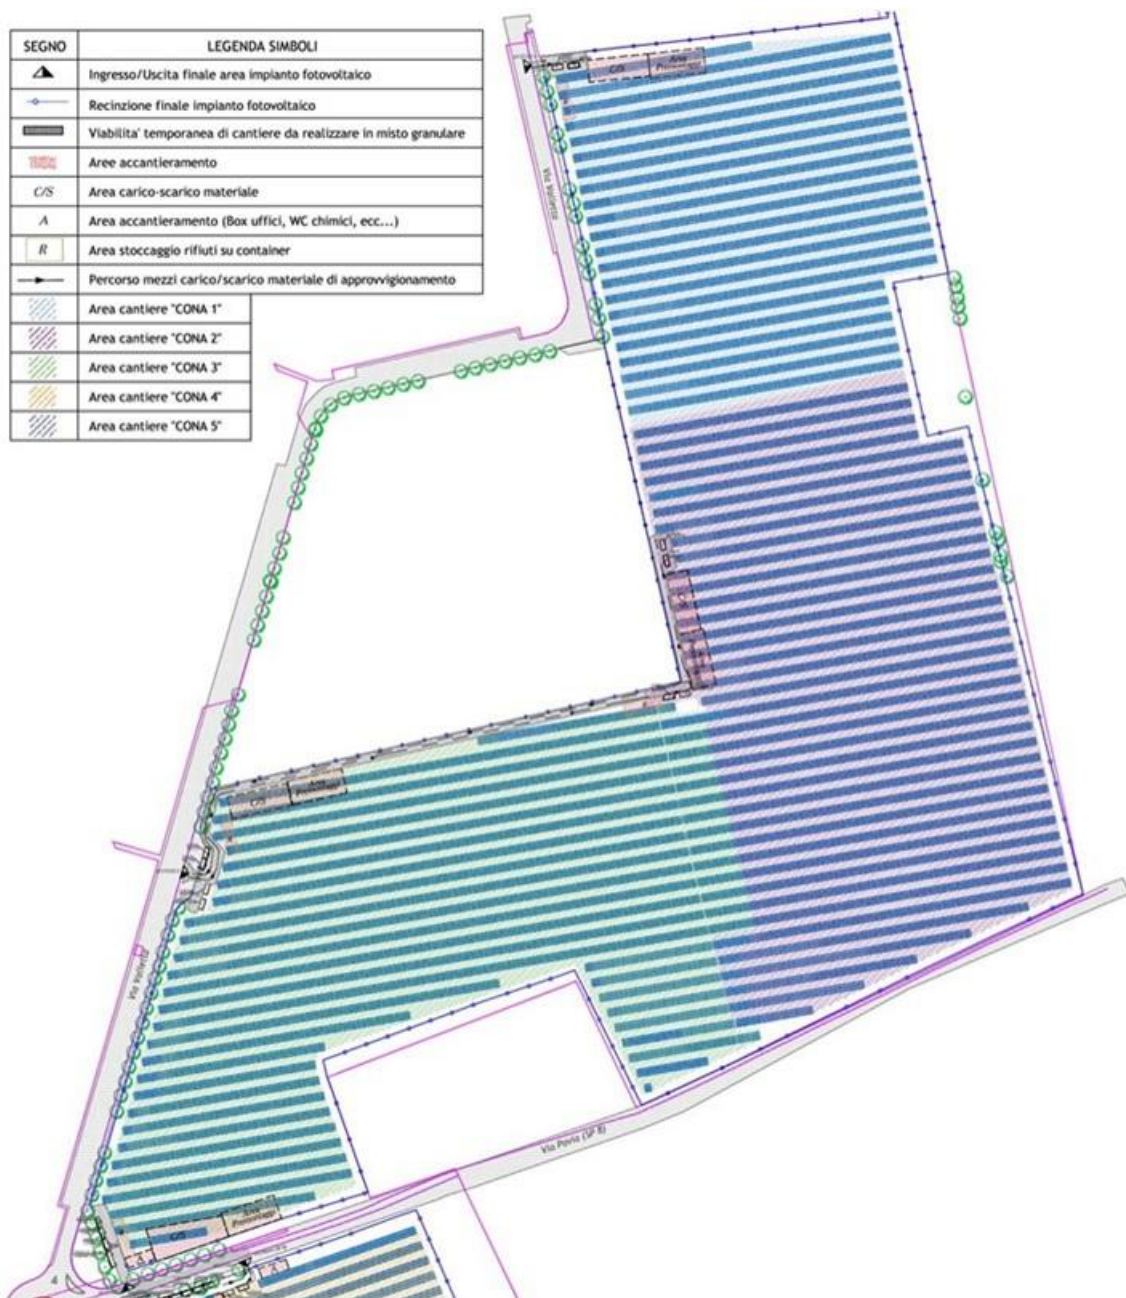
Aree di cantiere impianto CONA 1-2-3
